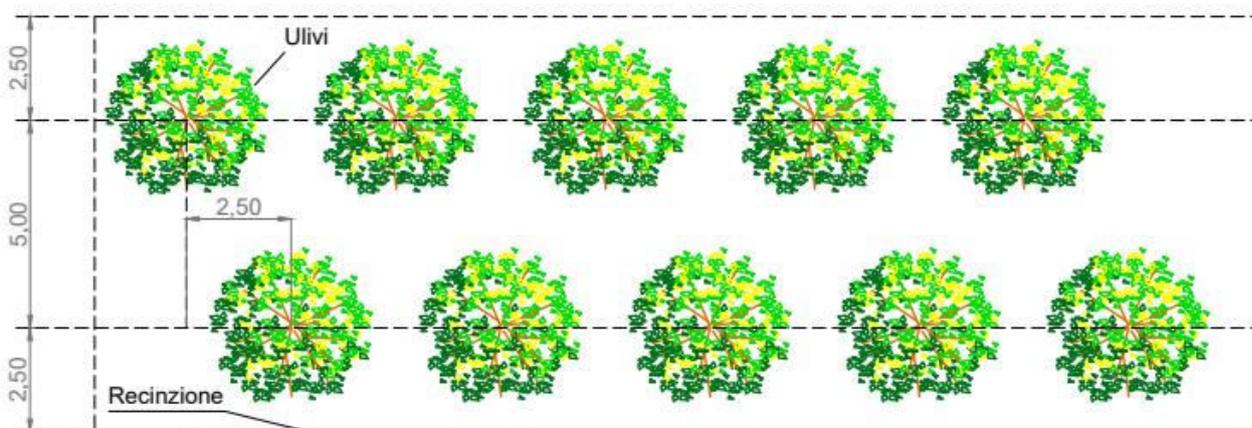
Fascia di mitigazione e schema del sesto dell'impianto
